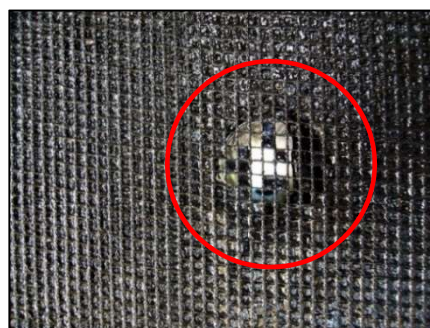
Situação desfavorável executada na obra. Membrana asfáltica passando sobre furo não tapado.
